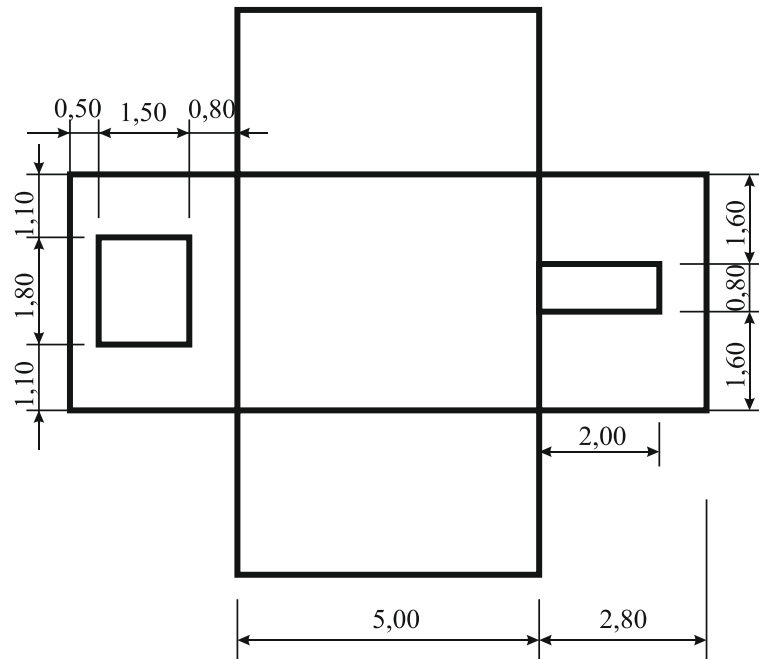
Развертка стен жилого помещения с размерами оконного и дверного проемов
